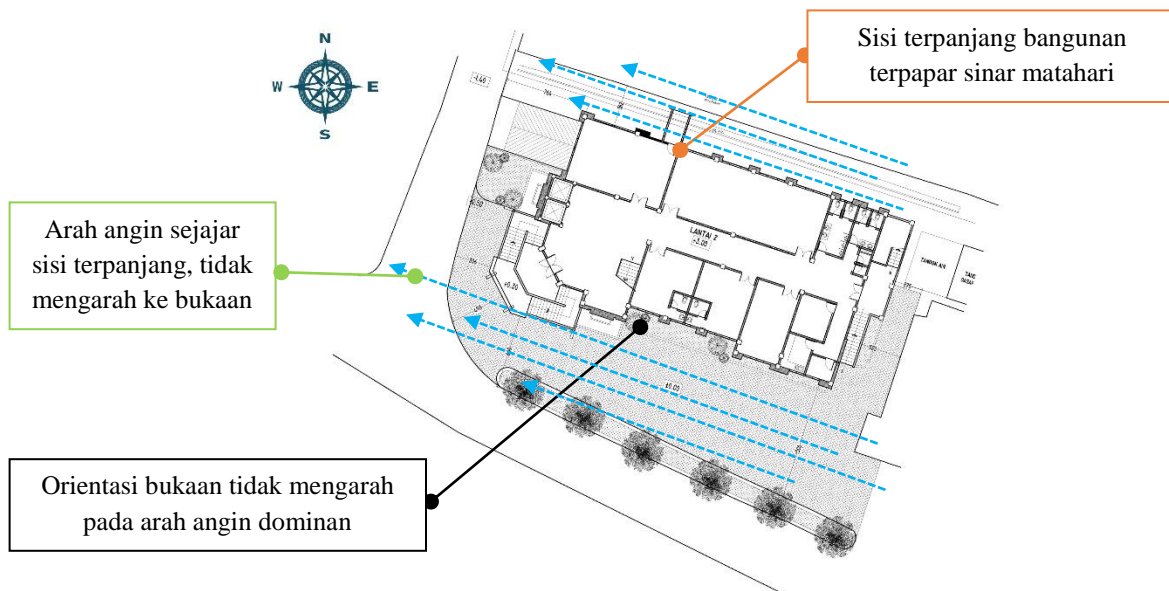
Tipe bukaan ventilasi pada ruang kuliah
